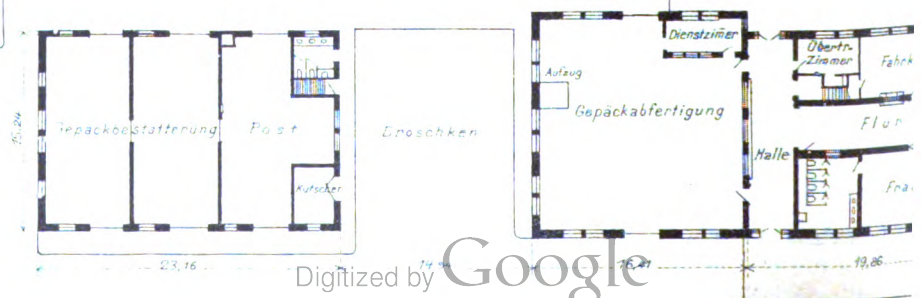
Grundriss des Empfangsgebäudes der
